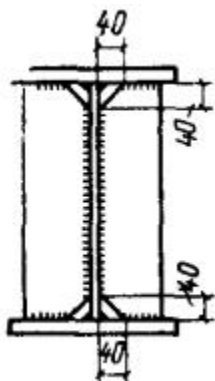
Примыкание ребер жесткости к элементам сечения сварной балки
